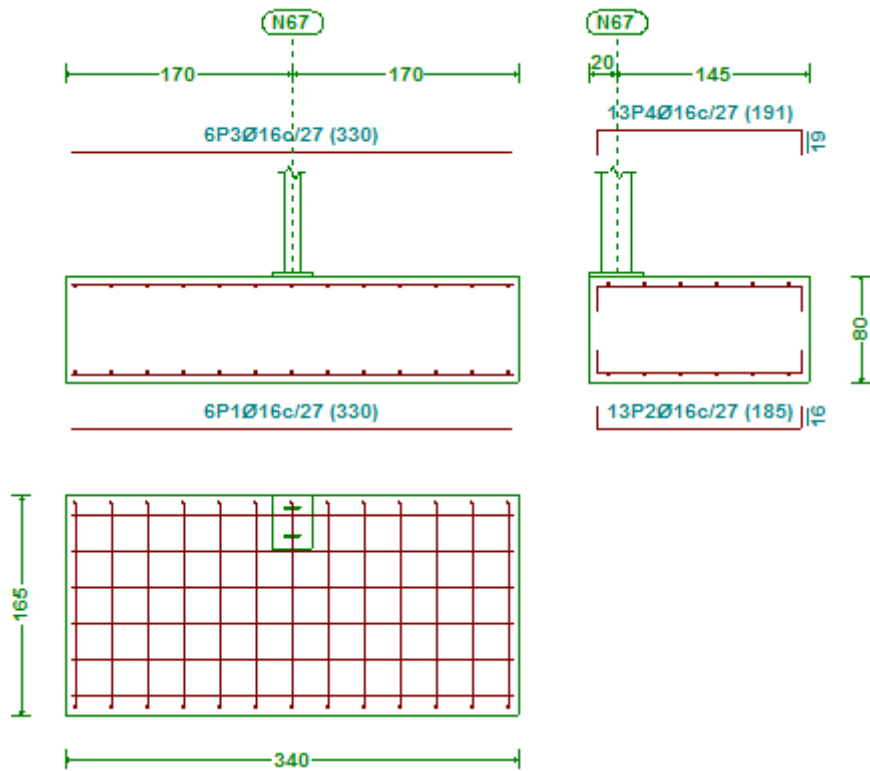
Zapatas pilar interior del pórtico de fachada trasero (Tipo 3)
